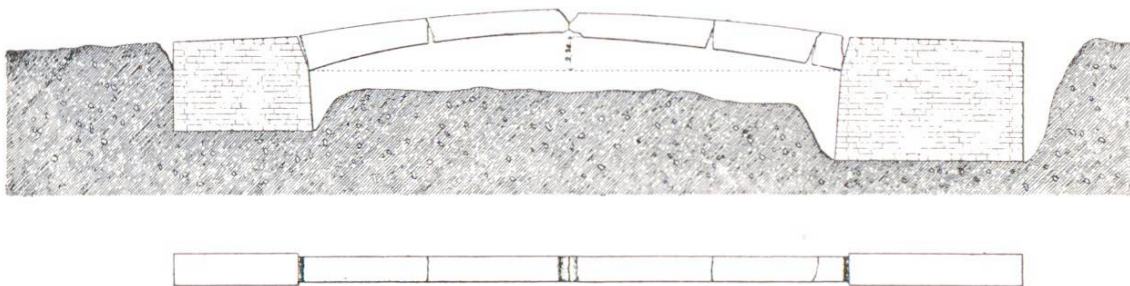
Ansicht und Grundriss des Bogens, als der ganze Schlussstein vernichtet war
